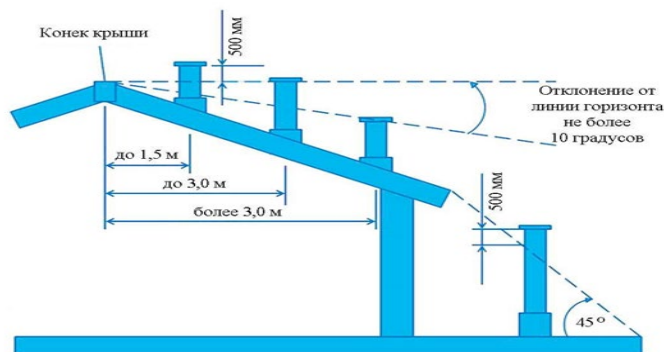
Схема размещения оголовков дымовых каналов на крышах зданий
